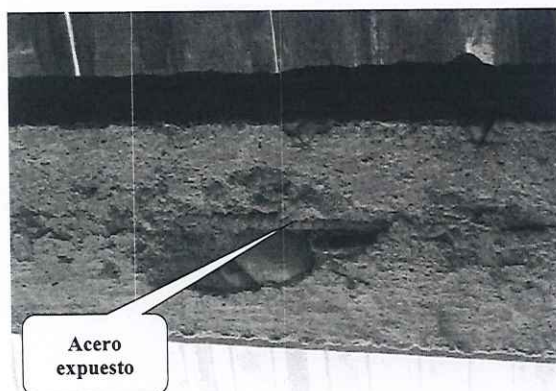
Vista de acero expuesto por falta de recubrimiento en viga
